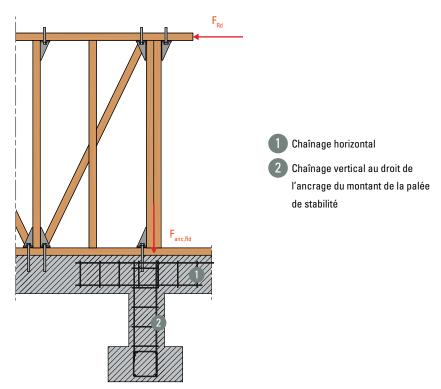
Exemple d'ancrage d'une palée de contreventement sur un sous-sol en béton armé
